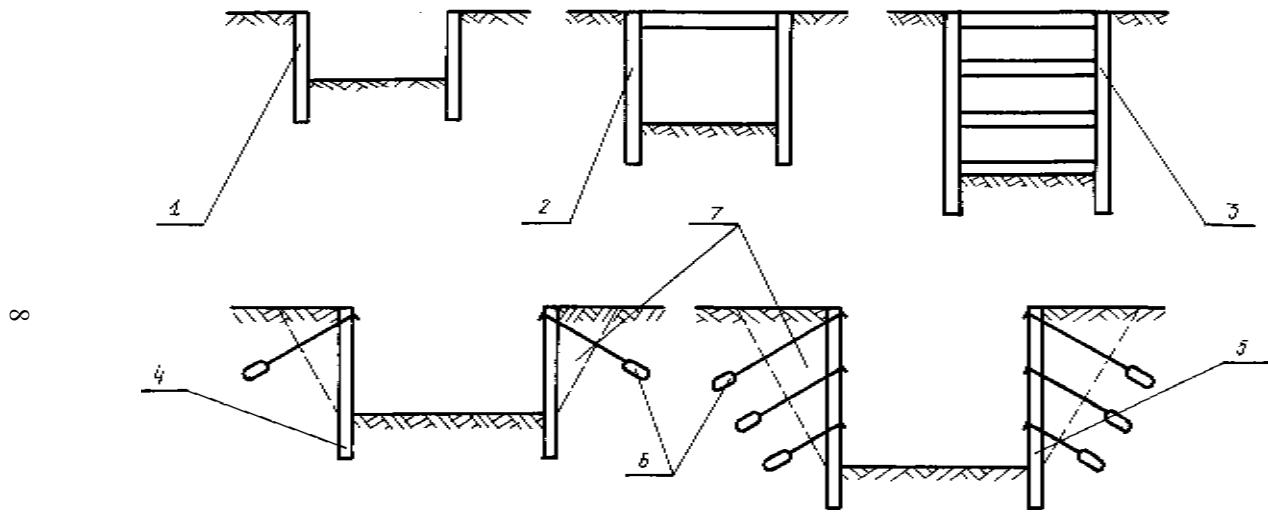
Конструктивные схемы стен подземных сооружений: 1 — консольная стена; 2—3 — стены с одно- и многоярусным креплением распорками; 4—5 — стены с одно- и многоярусным креплением анкерами; 6 — грунтовые анкеры; 7 — призма обрушения.
